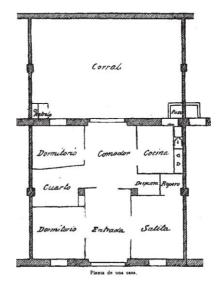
Esquema en planta de las viviendas. Fuente: "Las casas de obreros en Valencia. La construcción moderna" Gallego E.
